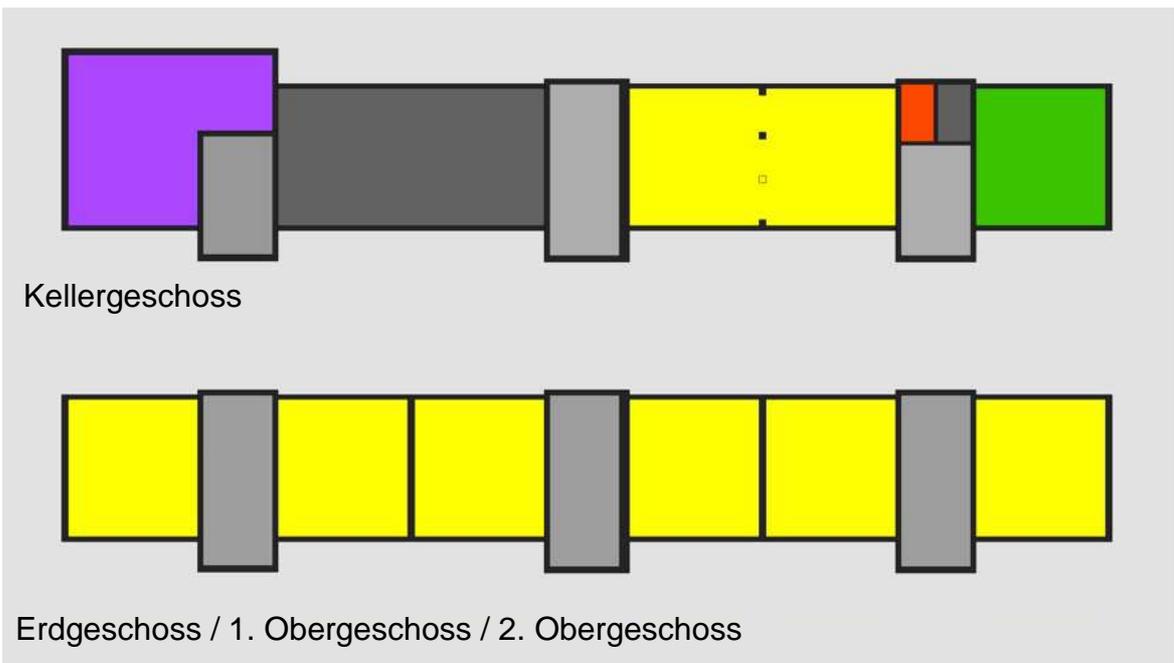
Klassenriegel, Grundriss mit Zonierung
